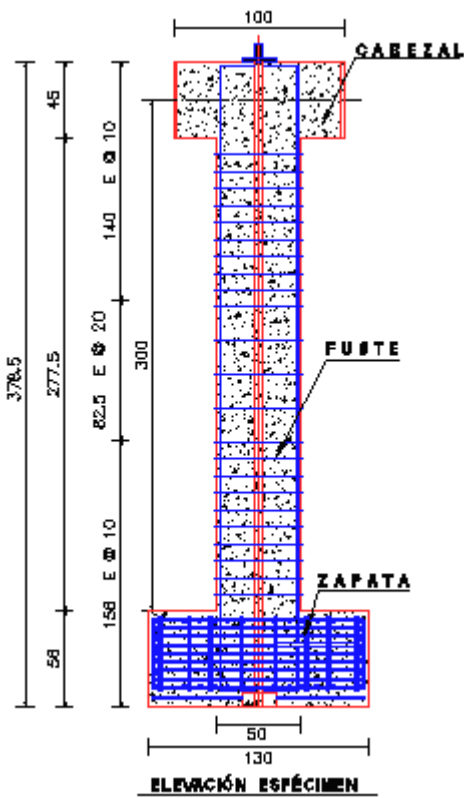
Distribución del refuerzo transversal en elevación y modelo experimental del espécimen de prueba.
